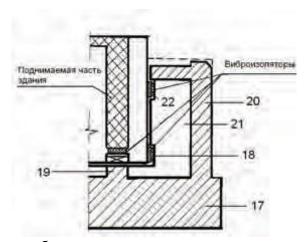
Схема виброизоляции цокольного этажа в основании здания.
